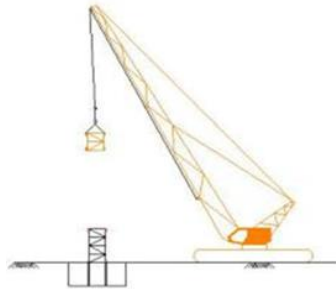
Pemasangan Pondasi *Tower Crane* Sebelum di Cor
